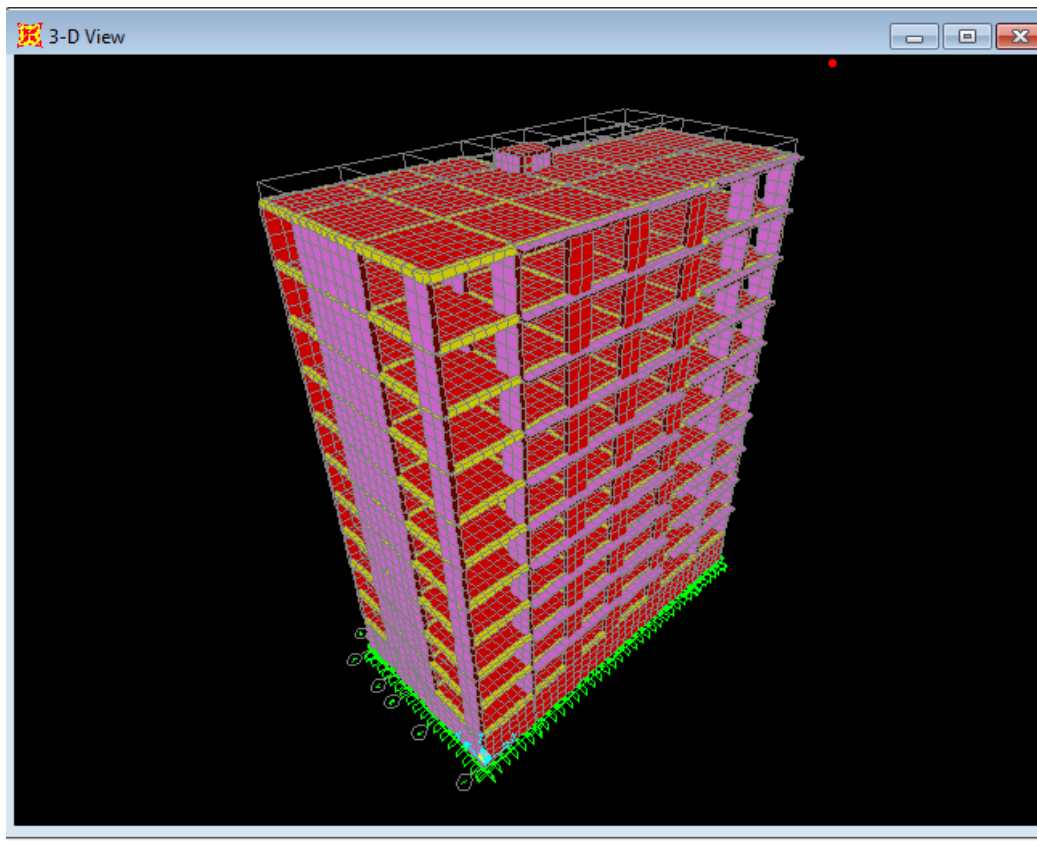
modélisation en 3D dans le SAP2000 (variante 2: structure en dalle pleine)
